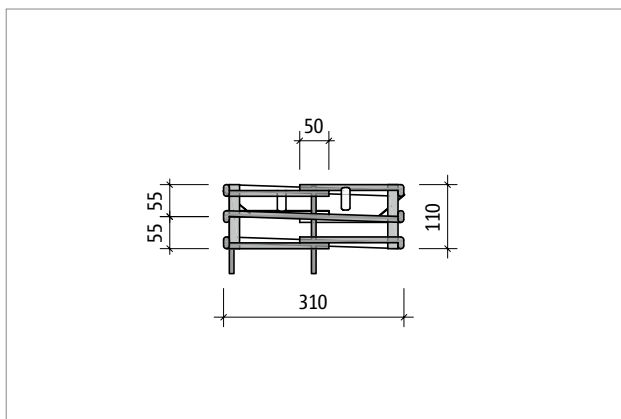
Schöck Scconnex® Typ P-B350: Seitenansicht Part T; geschweisste Bügel und Biegeformsegmente aus Edelstahl
